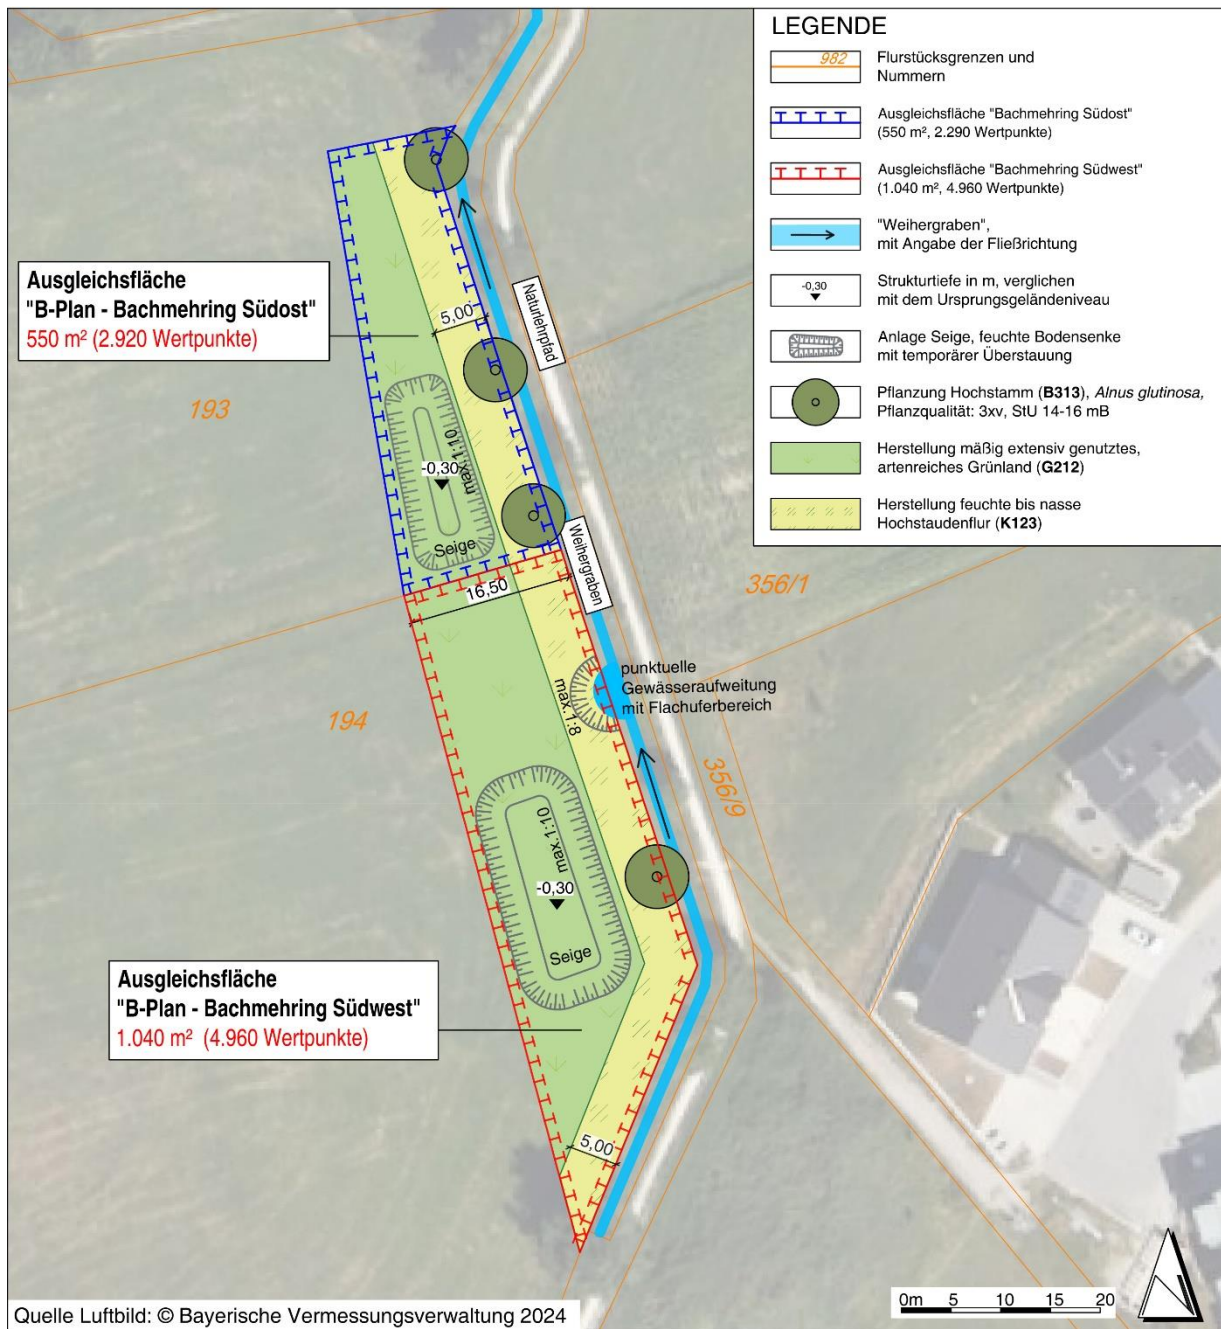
Lageplan der externen Ausgleichsfläche „Bachmehring Südwest“ (rot umrandet), ohne Maßstab, Luftbild: Bay. Vermessungsverwaltung 2024
